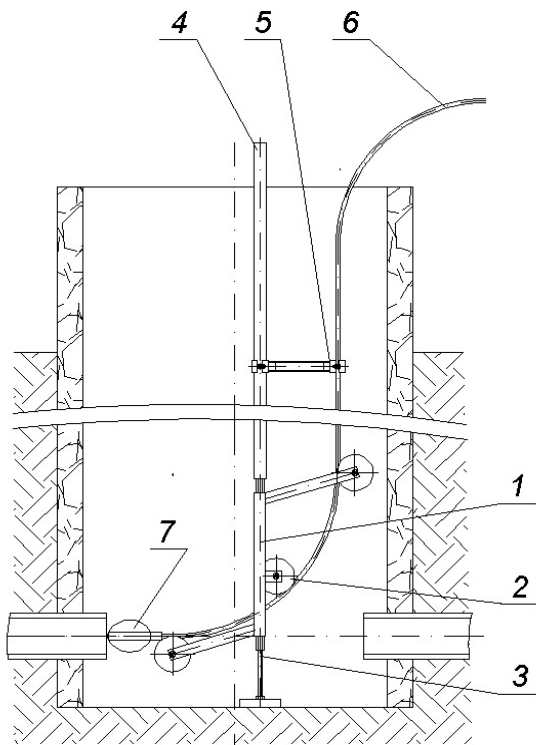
Штанга направляющая ШН-4 при очистке коллектора из колодца
